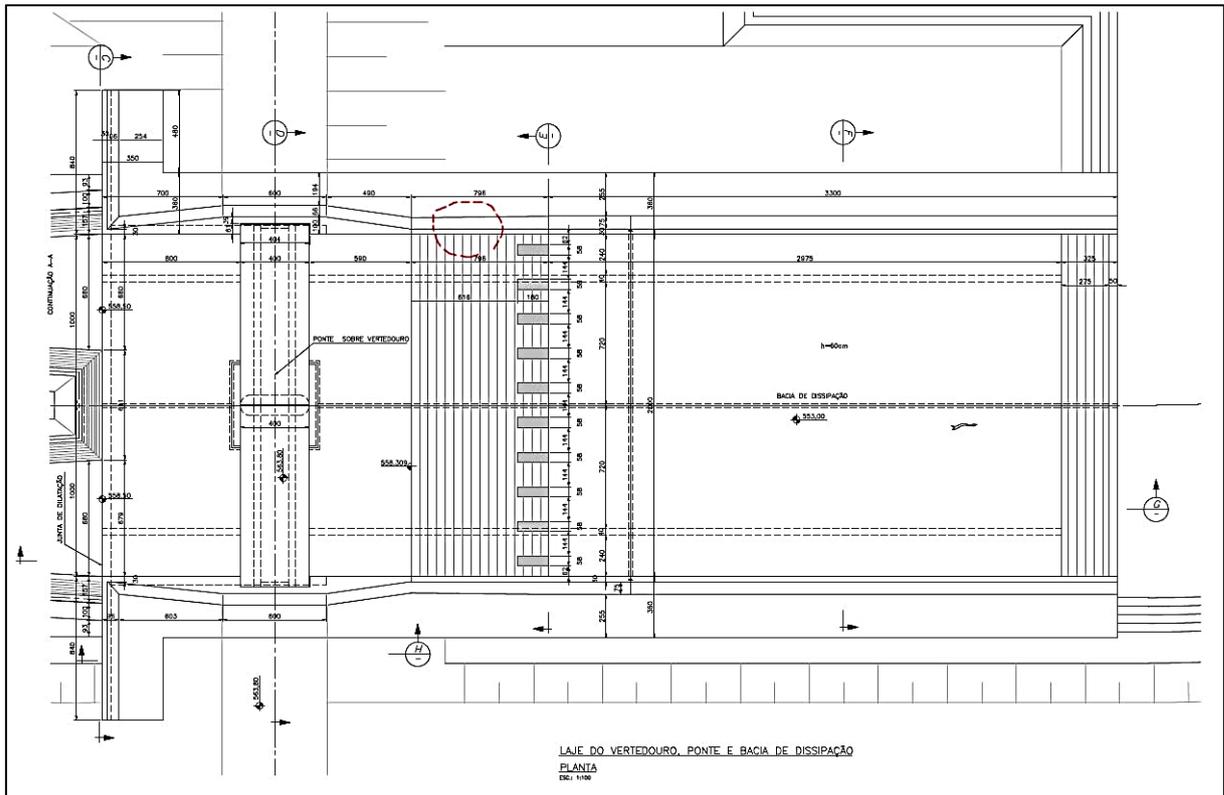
Planta do Vertedouro e Bacia de dissipação, com a localização da anomalia
